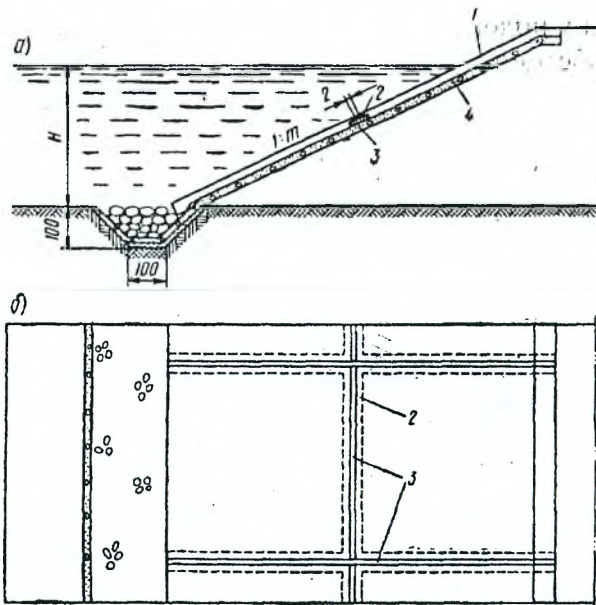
Укрепление откоса насыпи монолитными железобетонными плитами: а – разрез; б – план; 1 – монолитные железобетонные плиты; 2 – доска, пропитанная креозотом; 3 – железобетонная доска; 4 – щебеночная или гравийная подготовка
